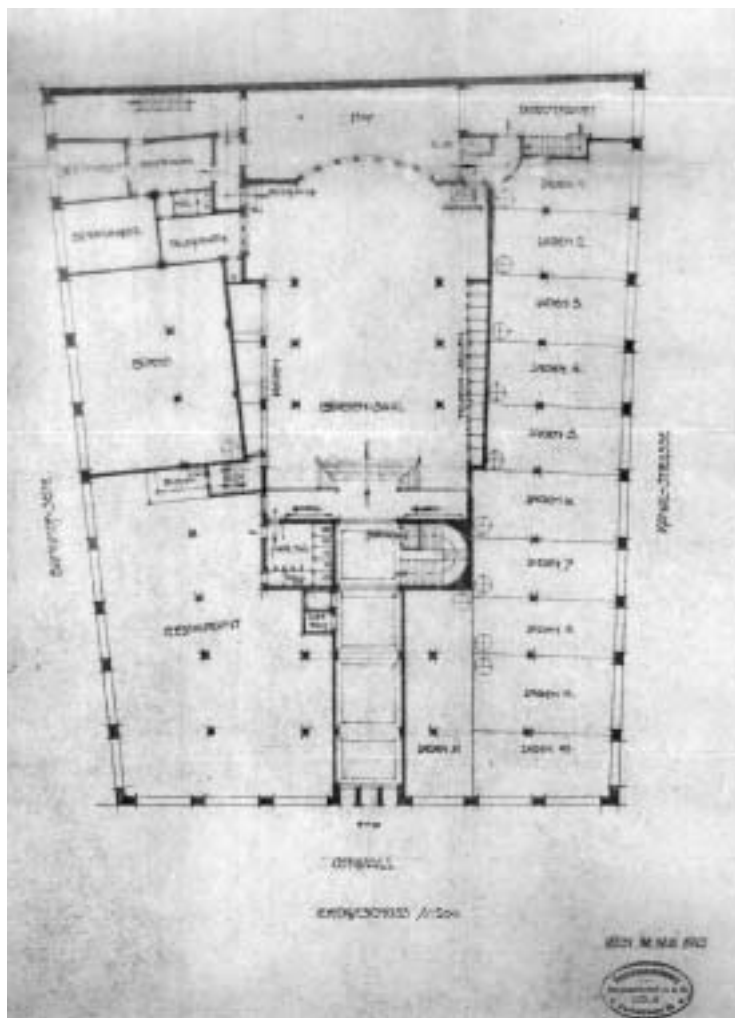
Grundriss Erdgeschoss, Entwurf von A. Koch, jr.
